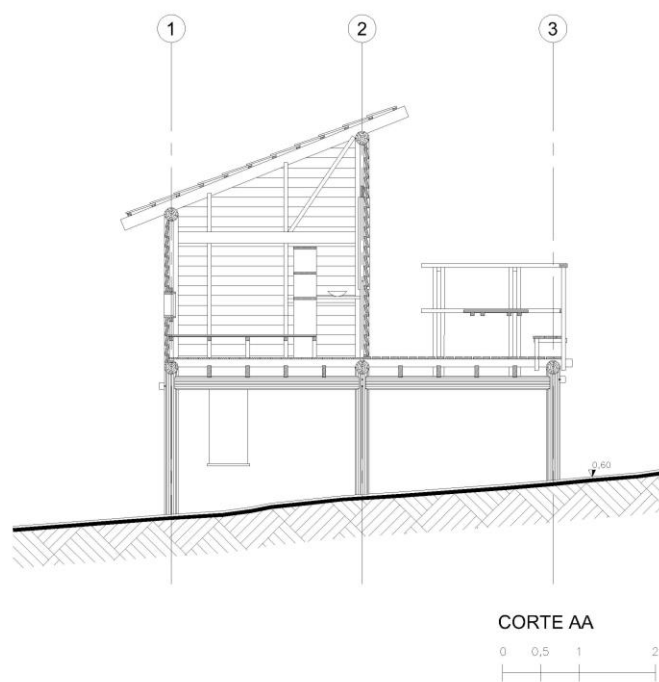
Desenho técnico do Corte AA. Desenho: Alexander Chang.
